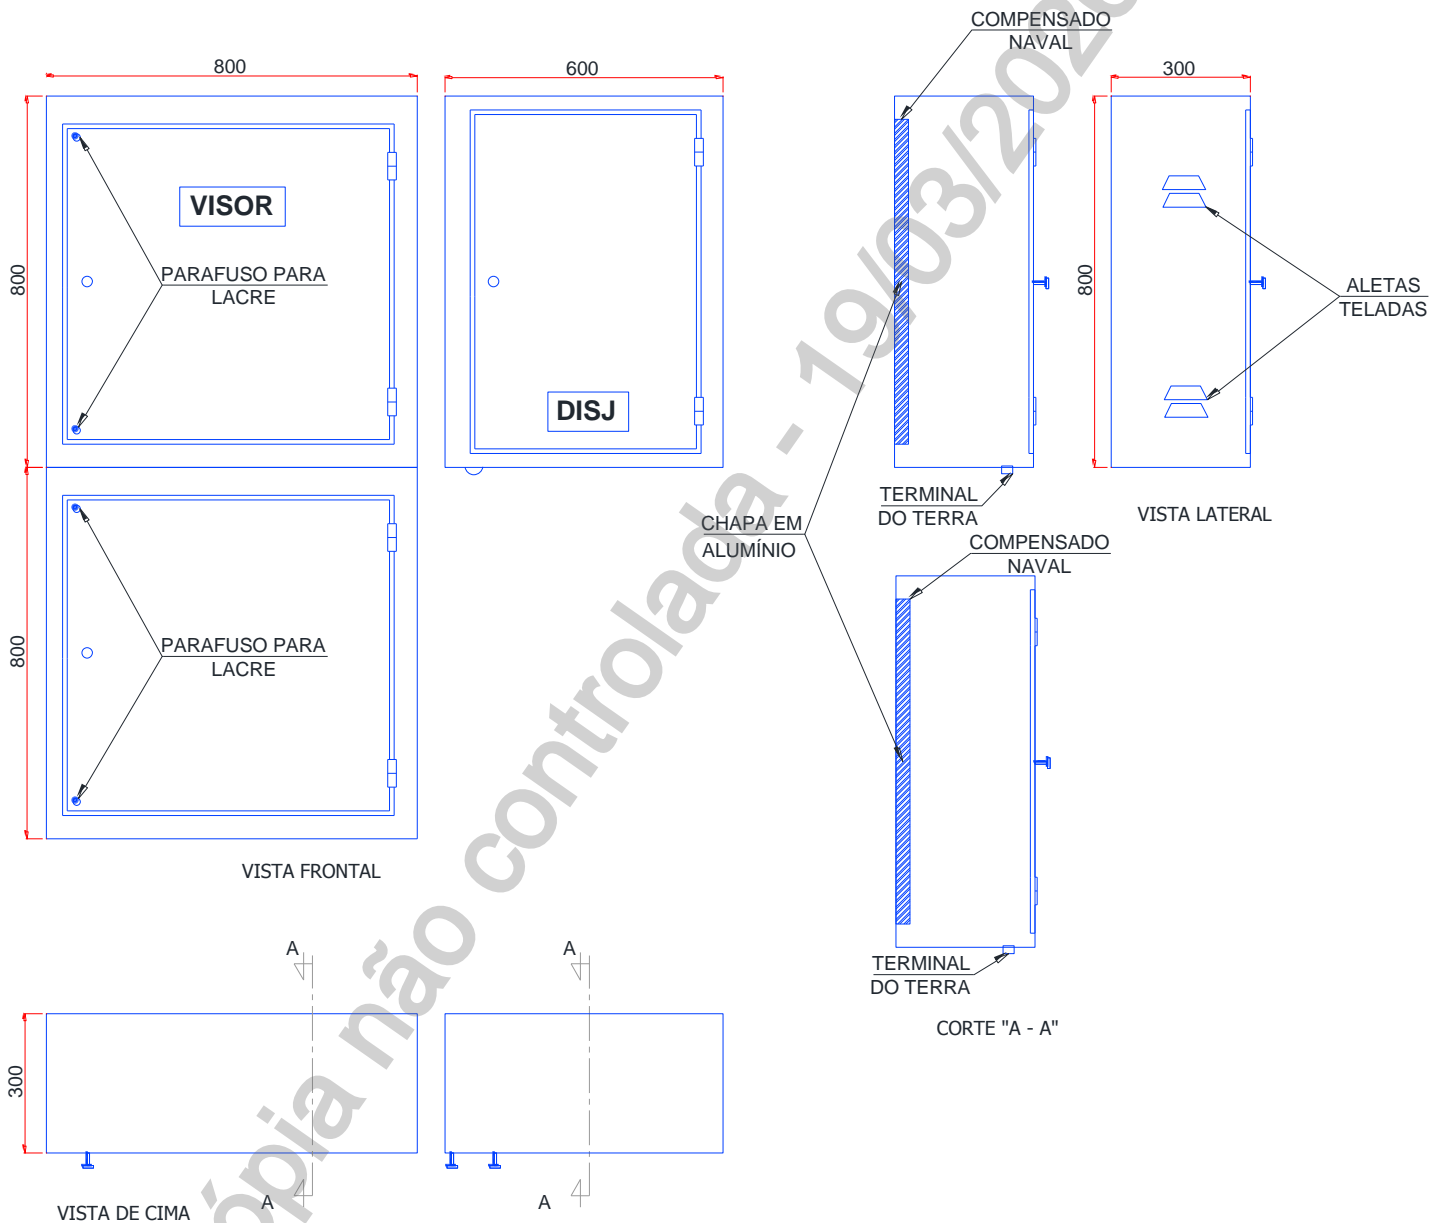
Caixa Metálica para Medição Indireta em Baixa Tensão Montagem Horizontal – 1/2
